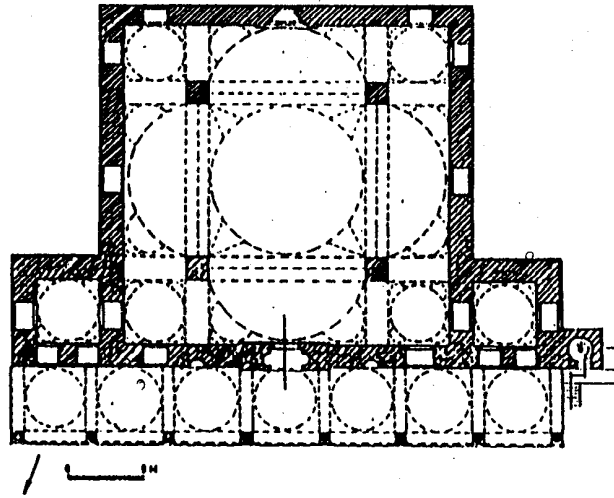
مسقط أفقي لجامع السلطان محمد جلبى في ديموتيقا باليونان
